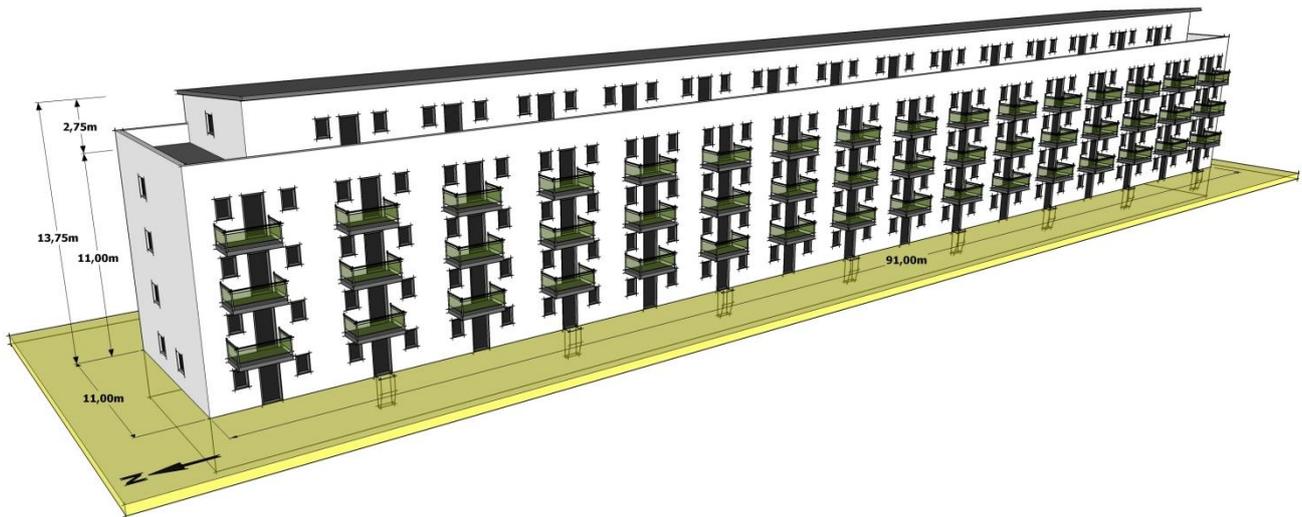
Mehrfamilienhaus groß mit 40 Wohneinheiten – Ansicht Nord-West
